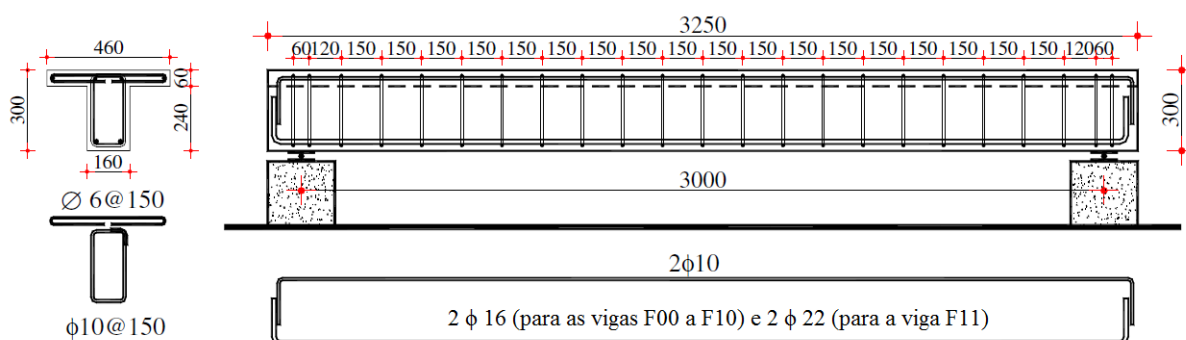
Dimensões em mm e detalhamento das vigas T (Hosny et al., 2006)
